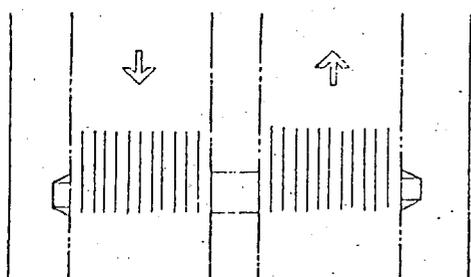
ESQUEMA DO CORTE DO CANTEIRO CENTRAL EM LOCAIS COM REBAIXAMENTO DE GUIA EM ESQUINA.
